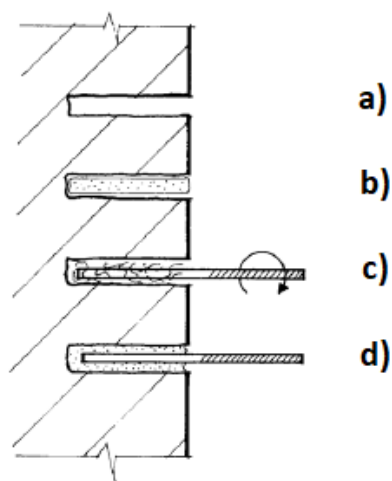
Ligação do tipo direta: a) Perfuração da alvenaria; b) Enchimento com argamassa não retráctil; c) Colocação do elemento metálico; d) Elemento metálico ancorado à fachada. Adaptado de [12]
